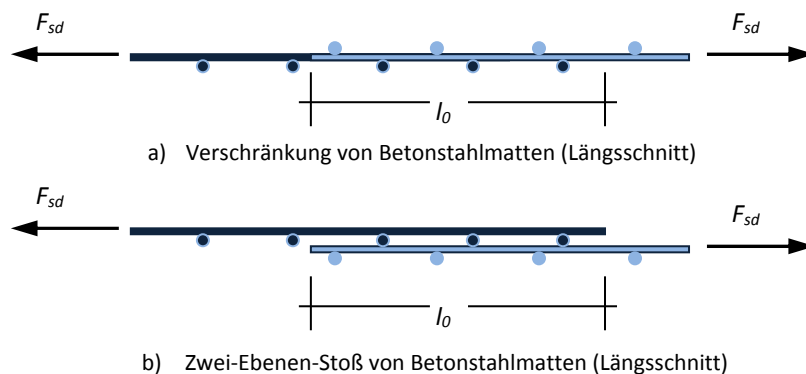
Stoß der Längsbewehrung (oder Hauptbewehrung) bei Betonstahlmatten
